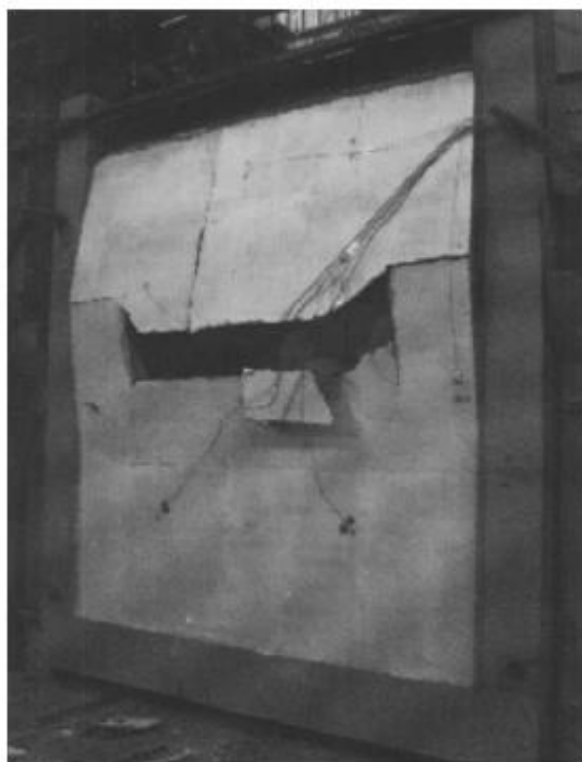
Ruptura da parede no Ensaio 4, vista do lado não exposto ao incêndio.
